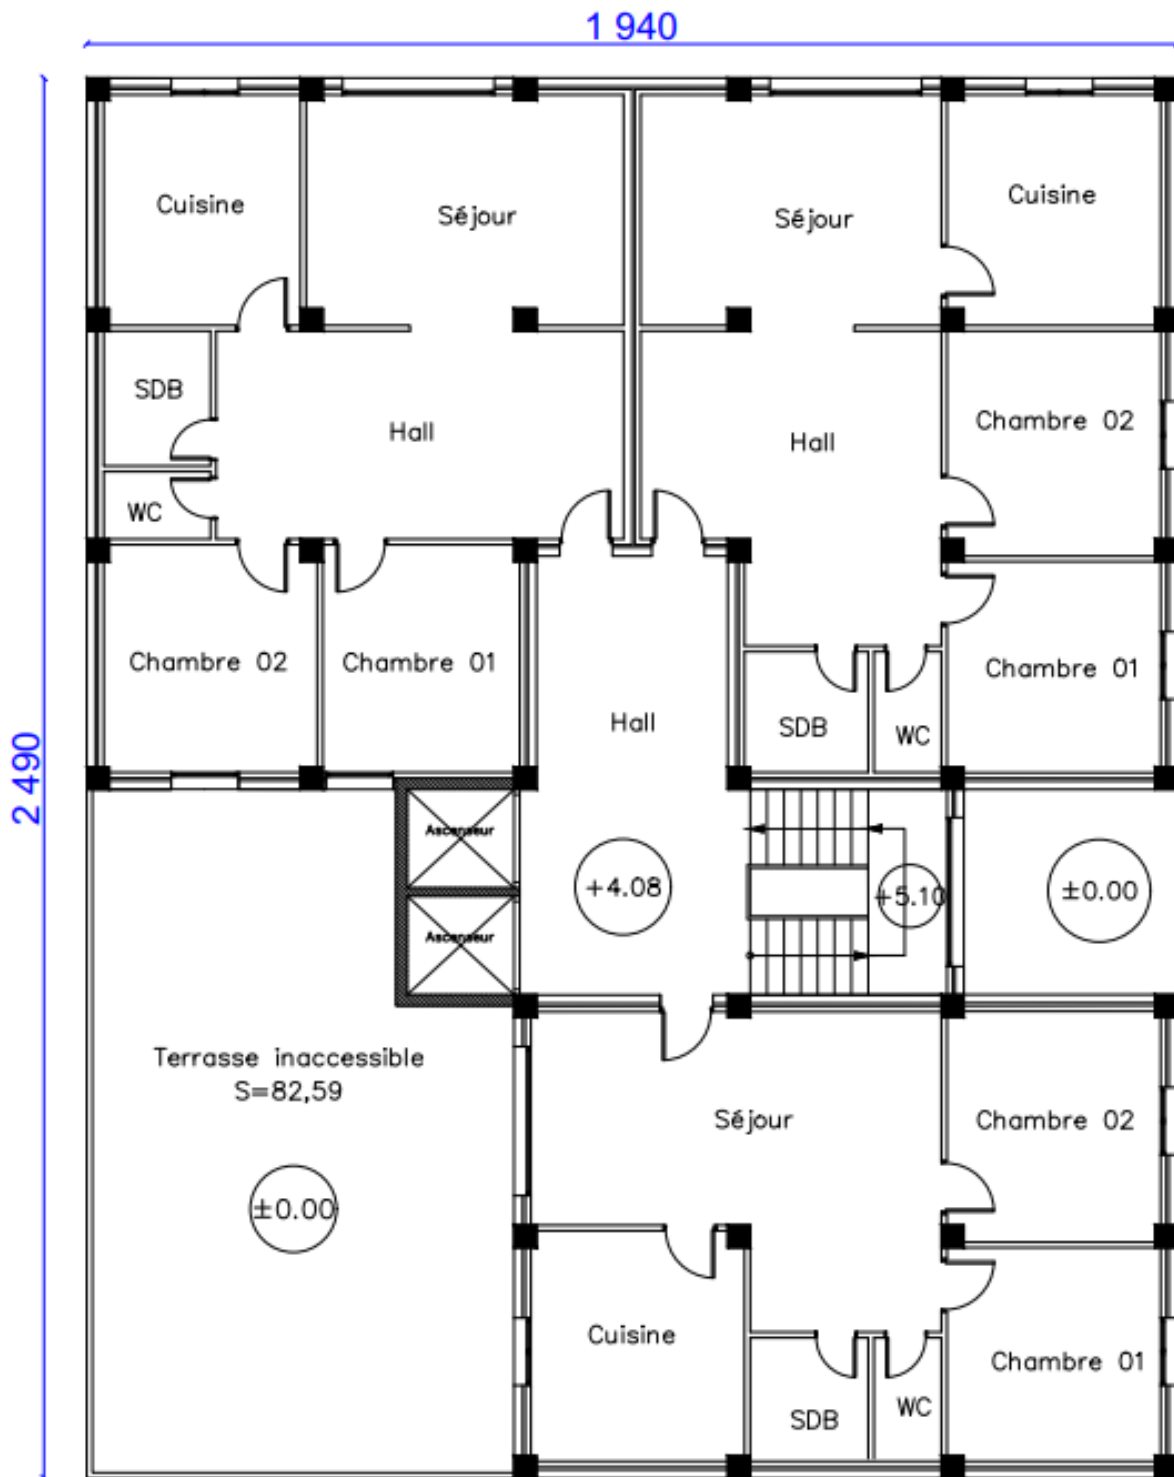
Plan d'un étage courant (1 jusqu'à 8)
